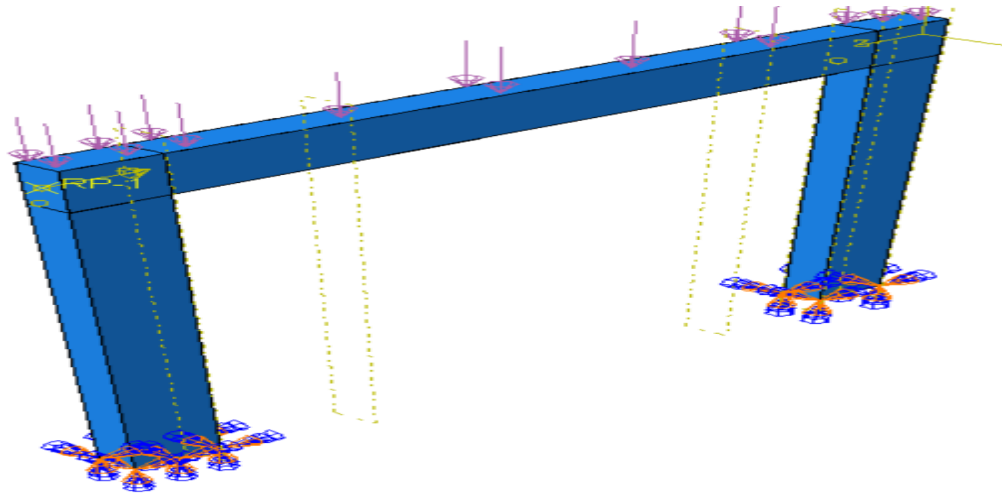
Assemblage de la poutre renforcée par les FRP et supportée par les poteaux
